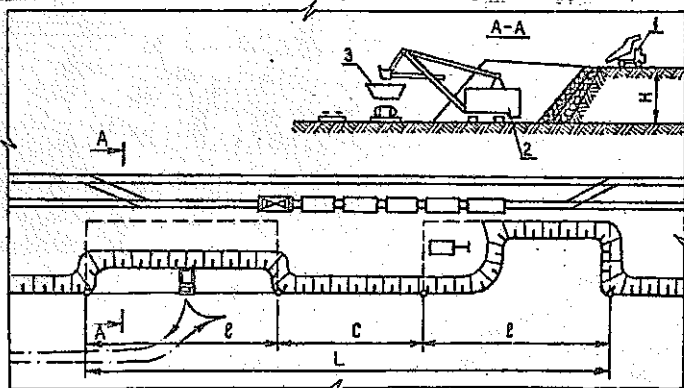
Схема отсыпки штабеля продольным фронтом
